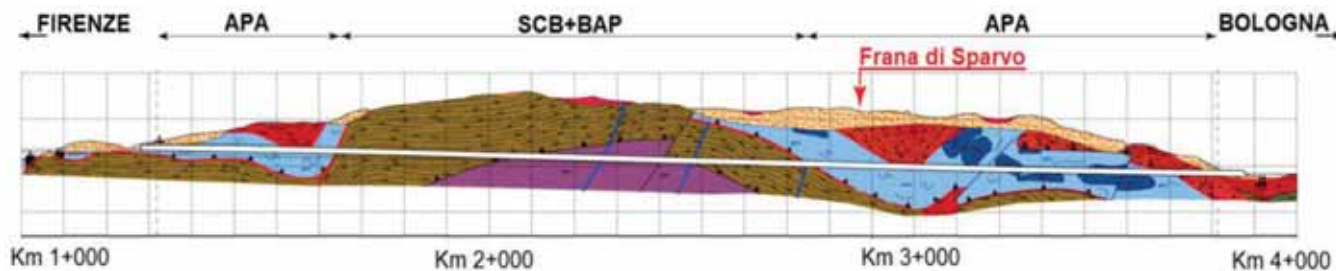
Galleria Sparvo - Profilo geomeccanico.
